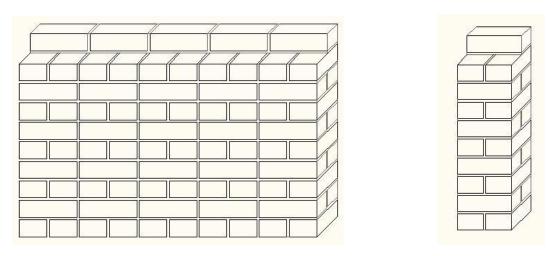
Disposición de las hiladas del muro y del pilar según aparejo inglés. Elaboración propia
